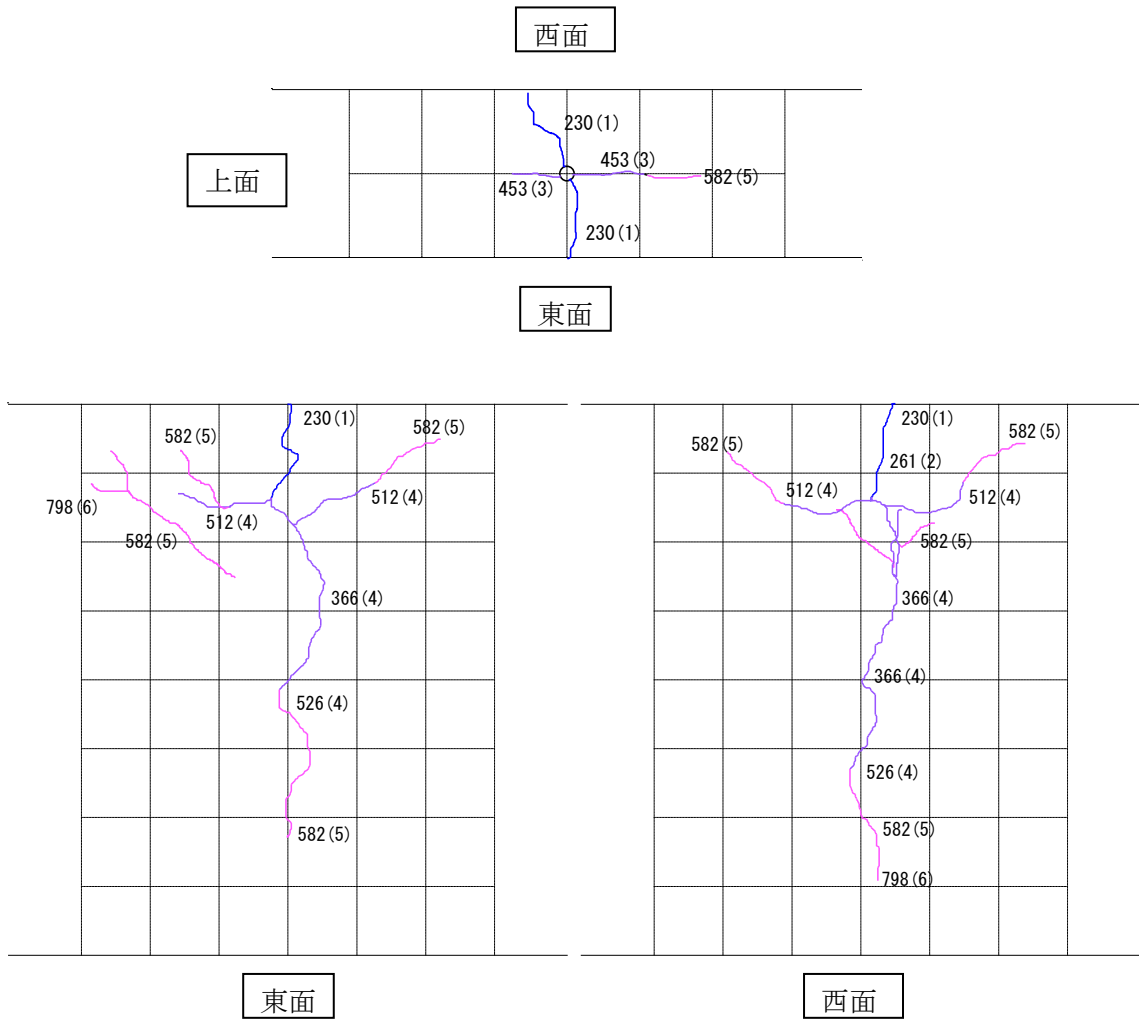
梁幅 220SD685 試験体のひびわれ状況
